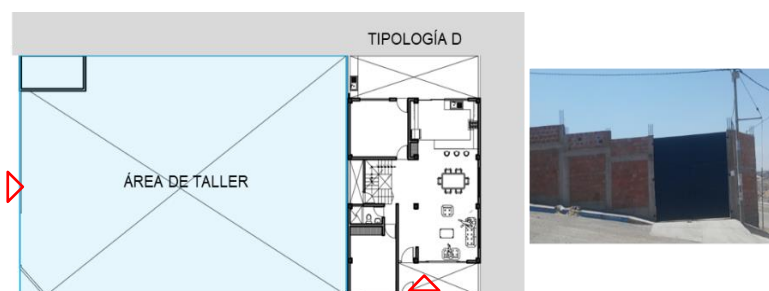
Vivienda al fondo del terreno (lote esquinero)
